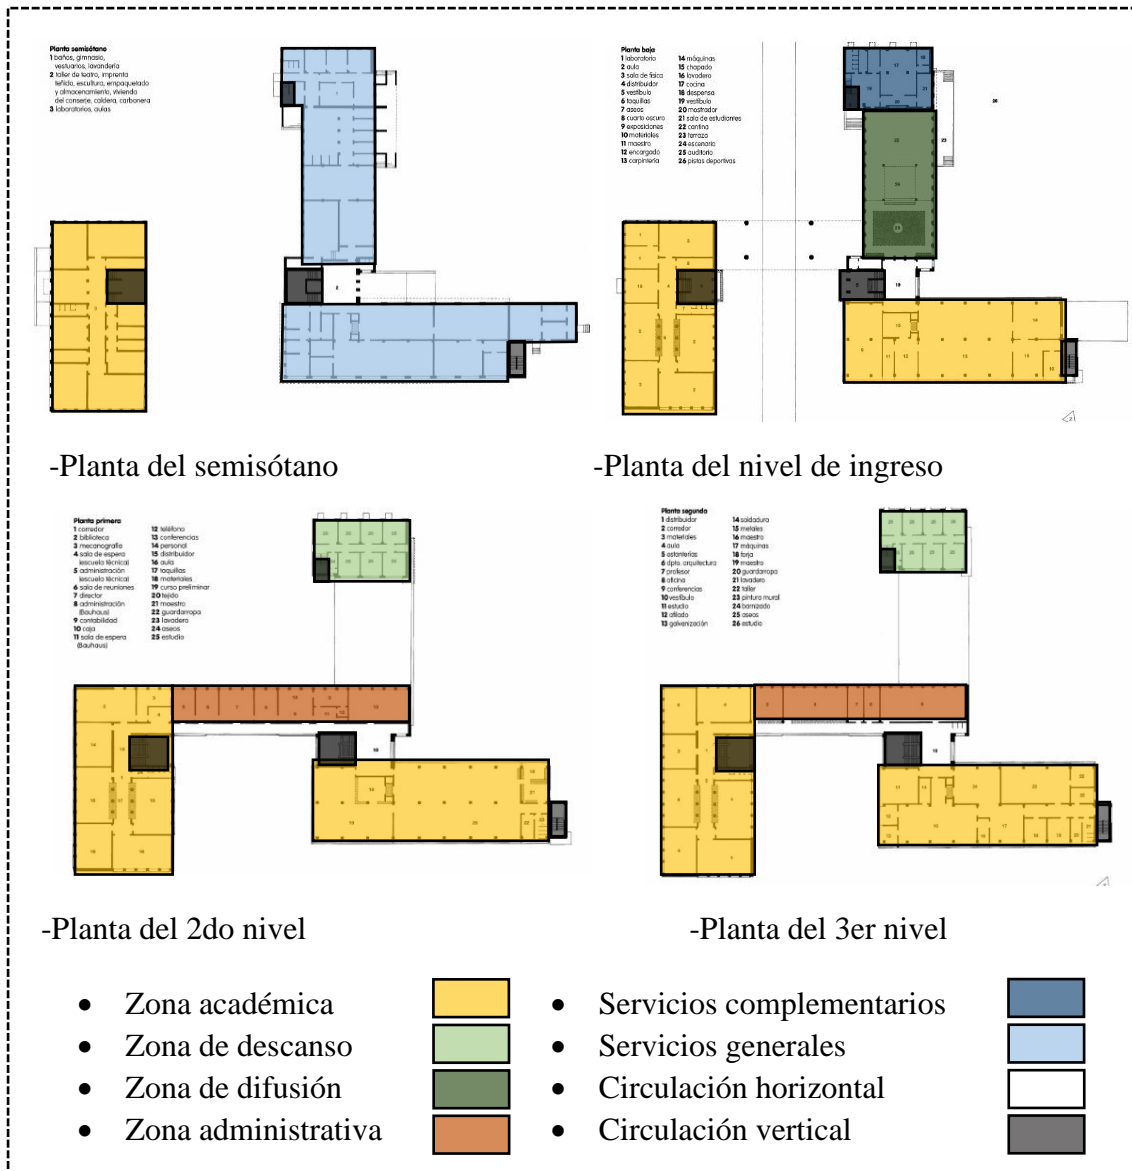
Plantas de Campus Dessau. (Fuente: Archdaily)
